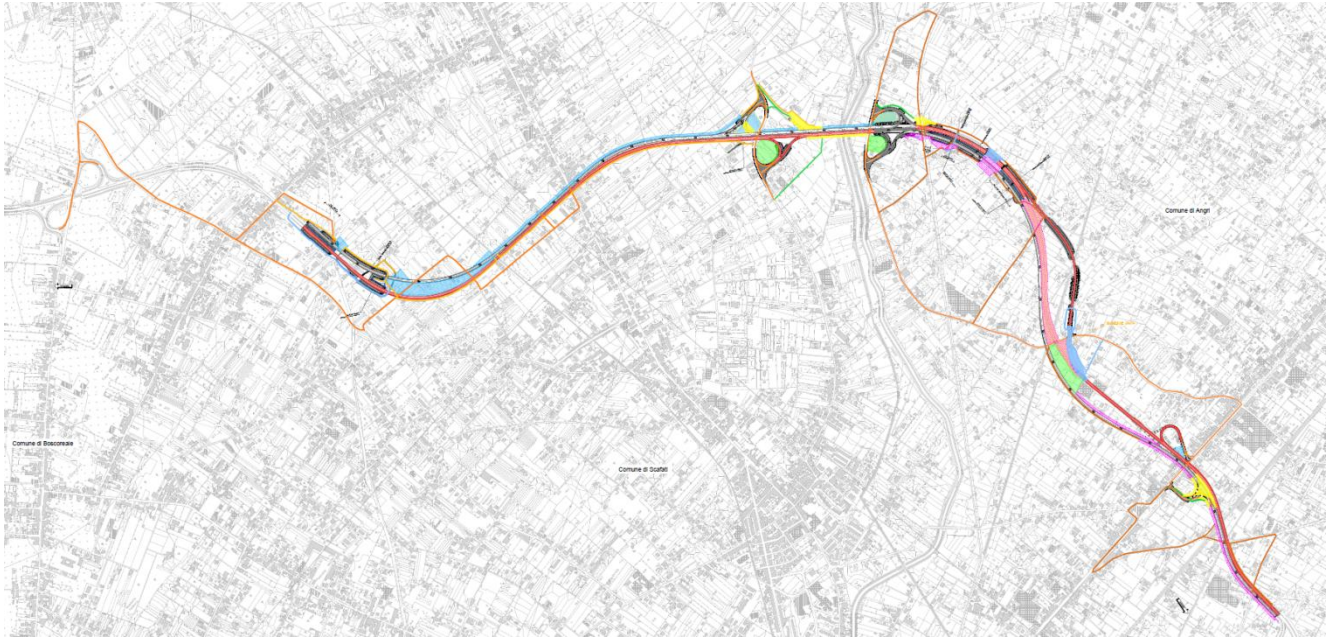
Planimetria attività di cantiere Lotto 2 – Fase 4
